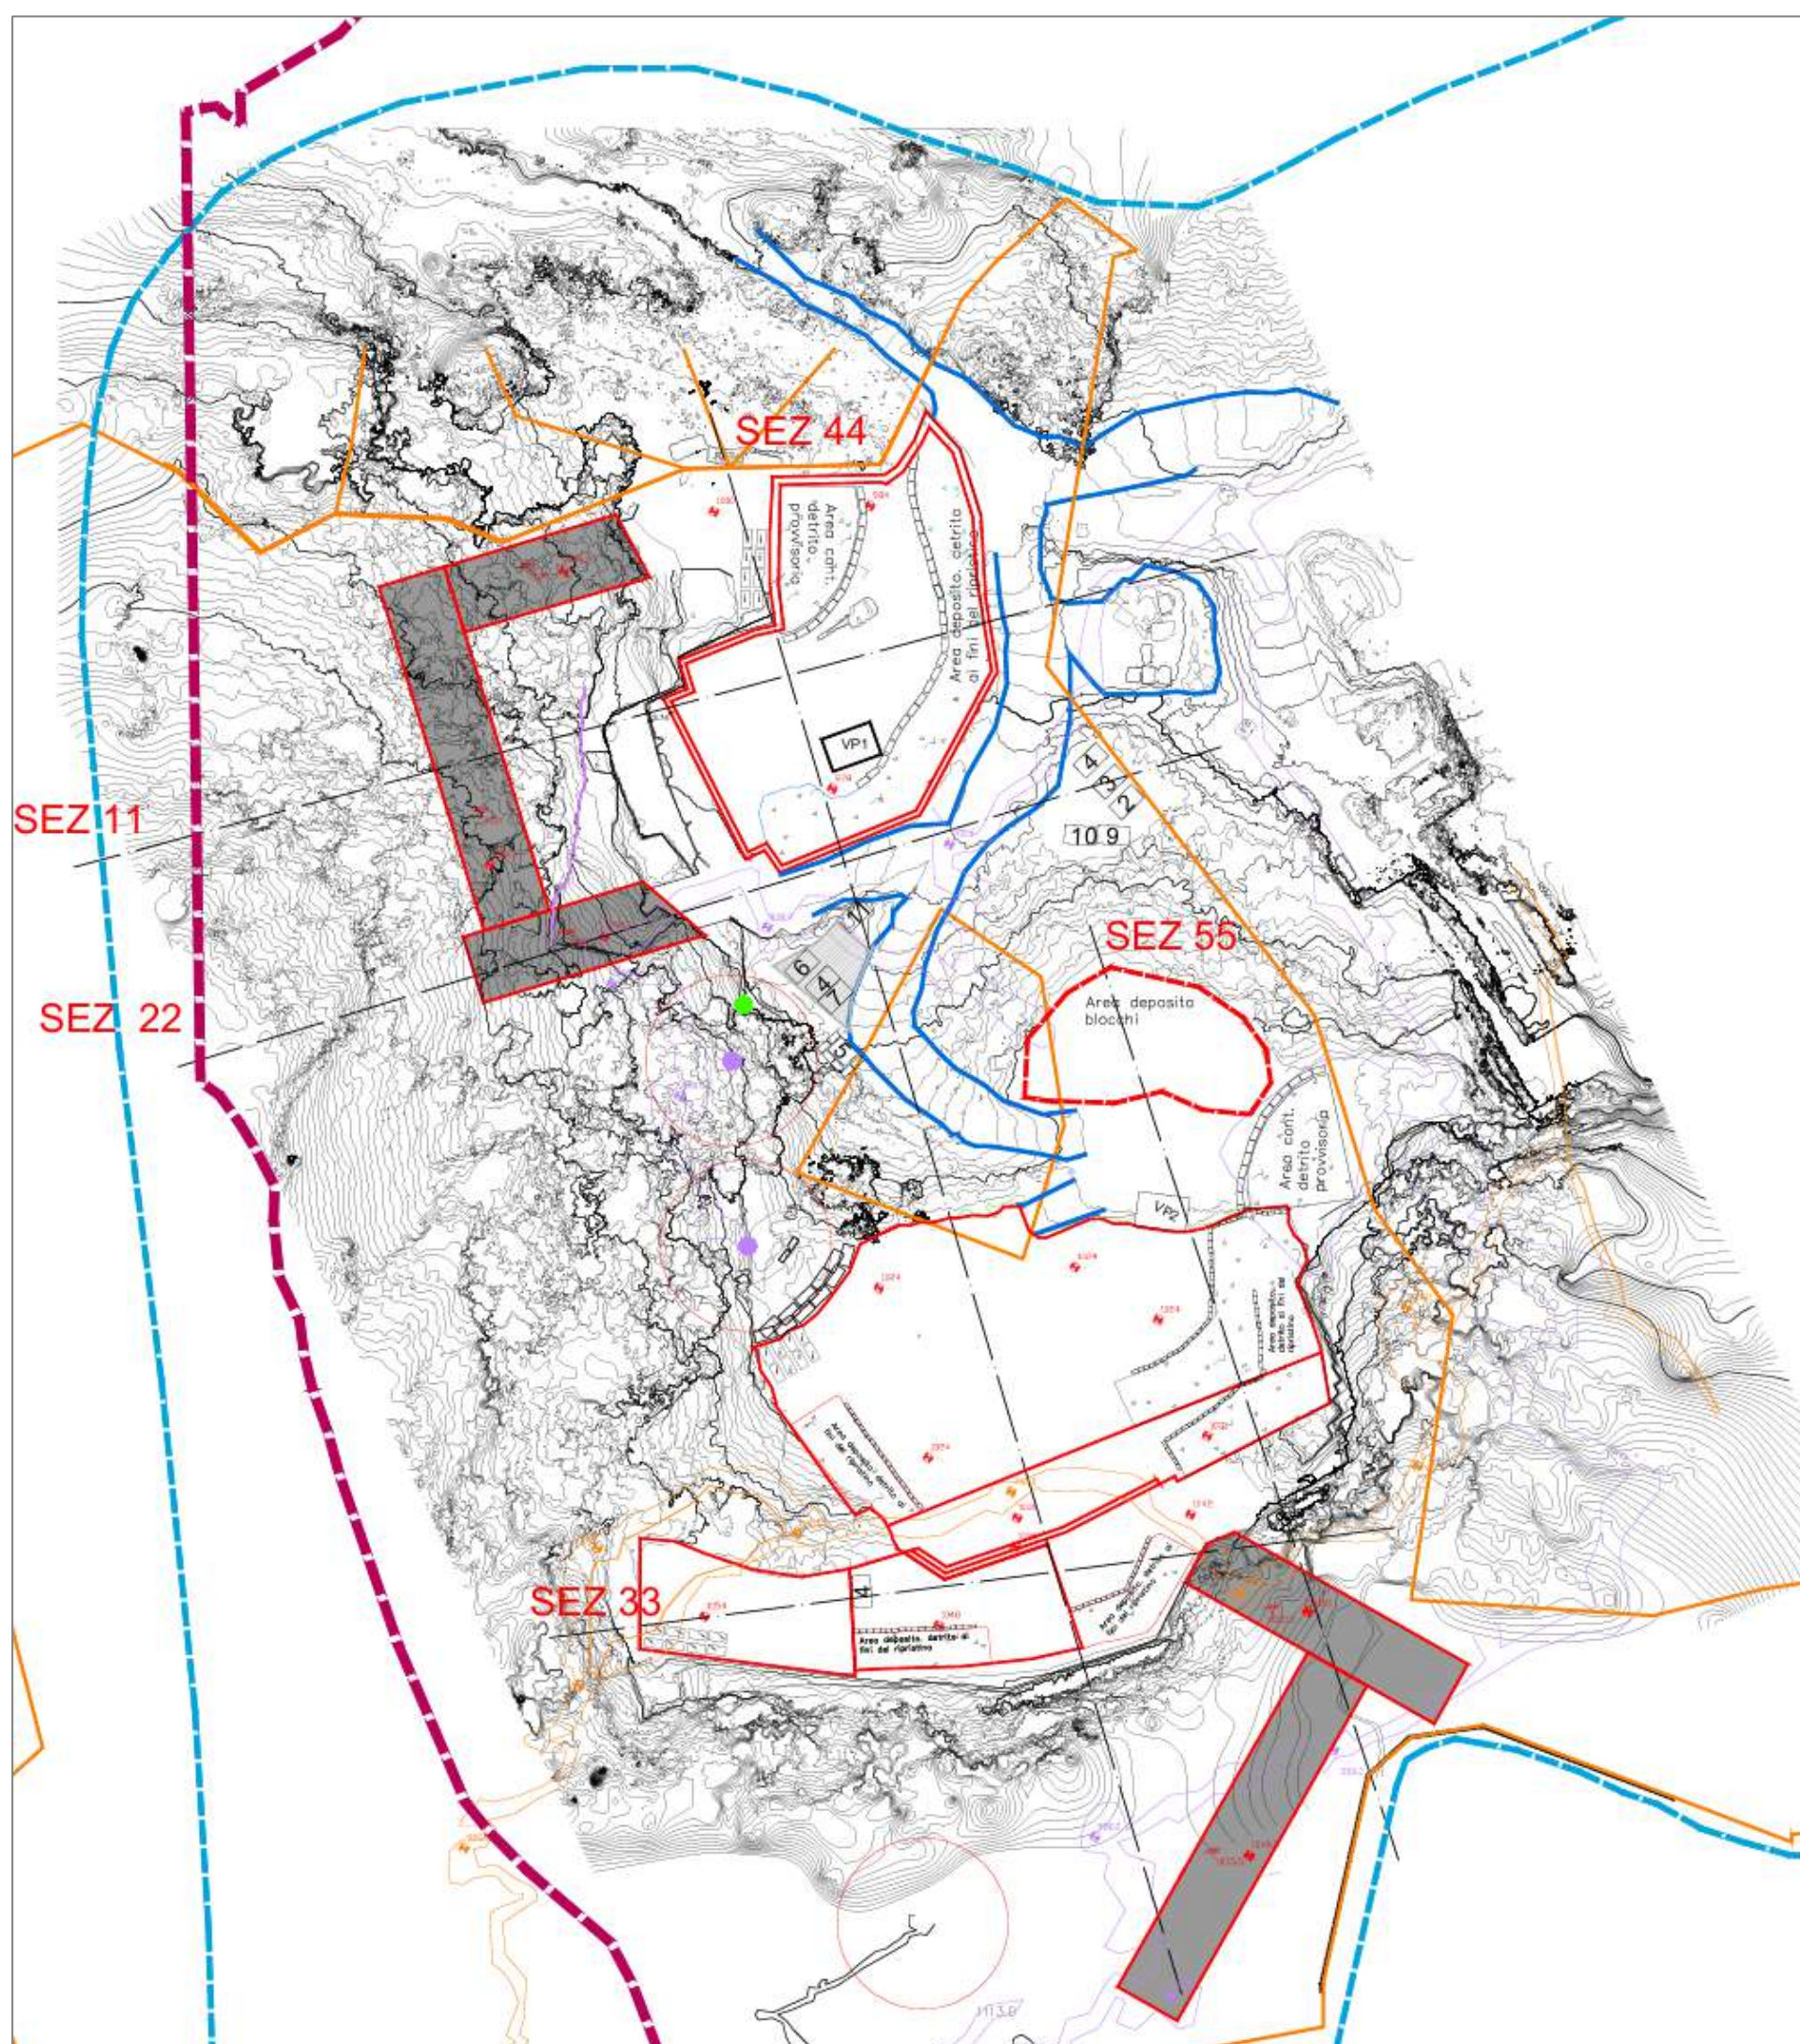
Planimetria FASE 2 (Tav. 9.2).
